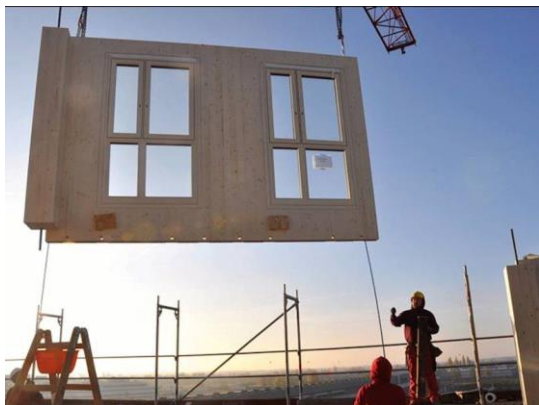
Dokumentation der Bauausführung, Betonkern mit Holzkonstruktion [93]
